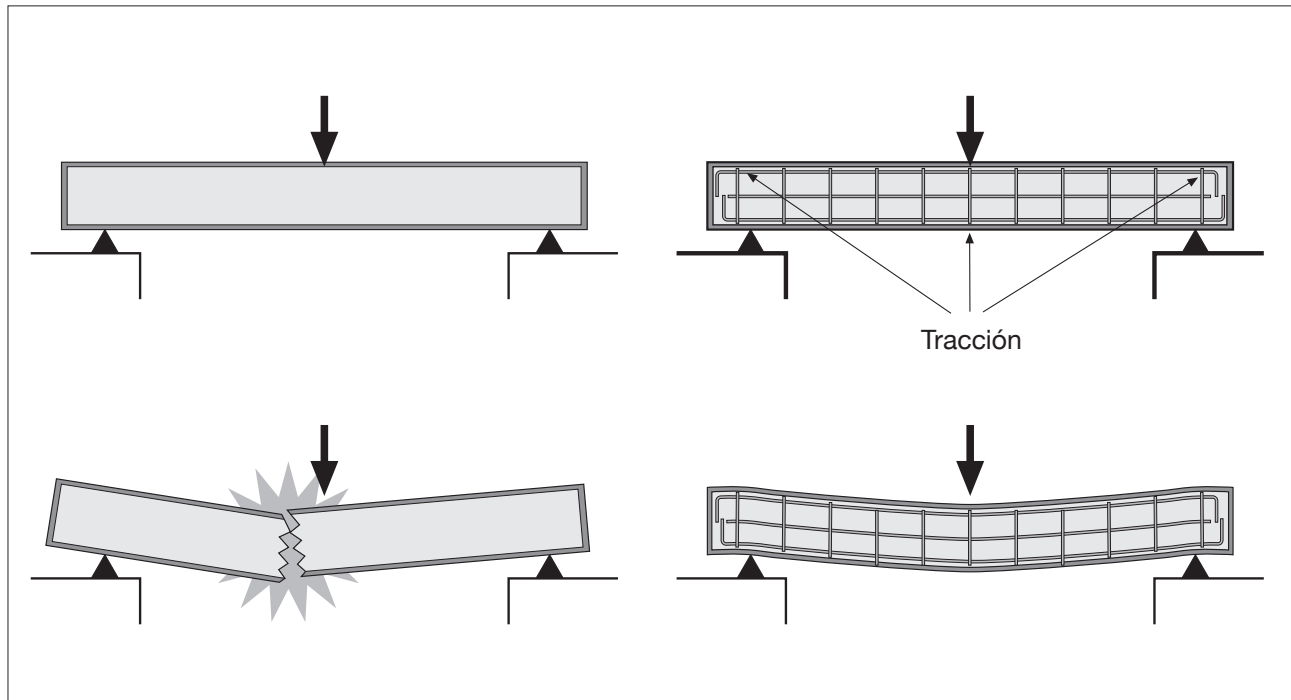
Ejemplo de viga cargada, sin y con armaduras sometidas a tensiones.
